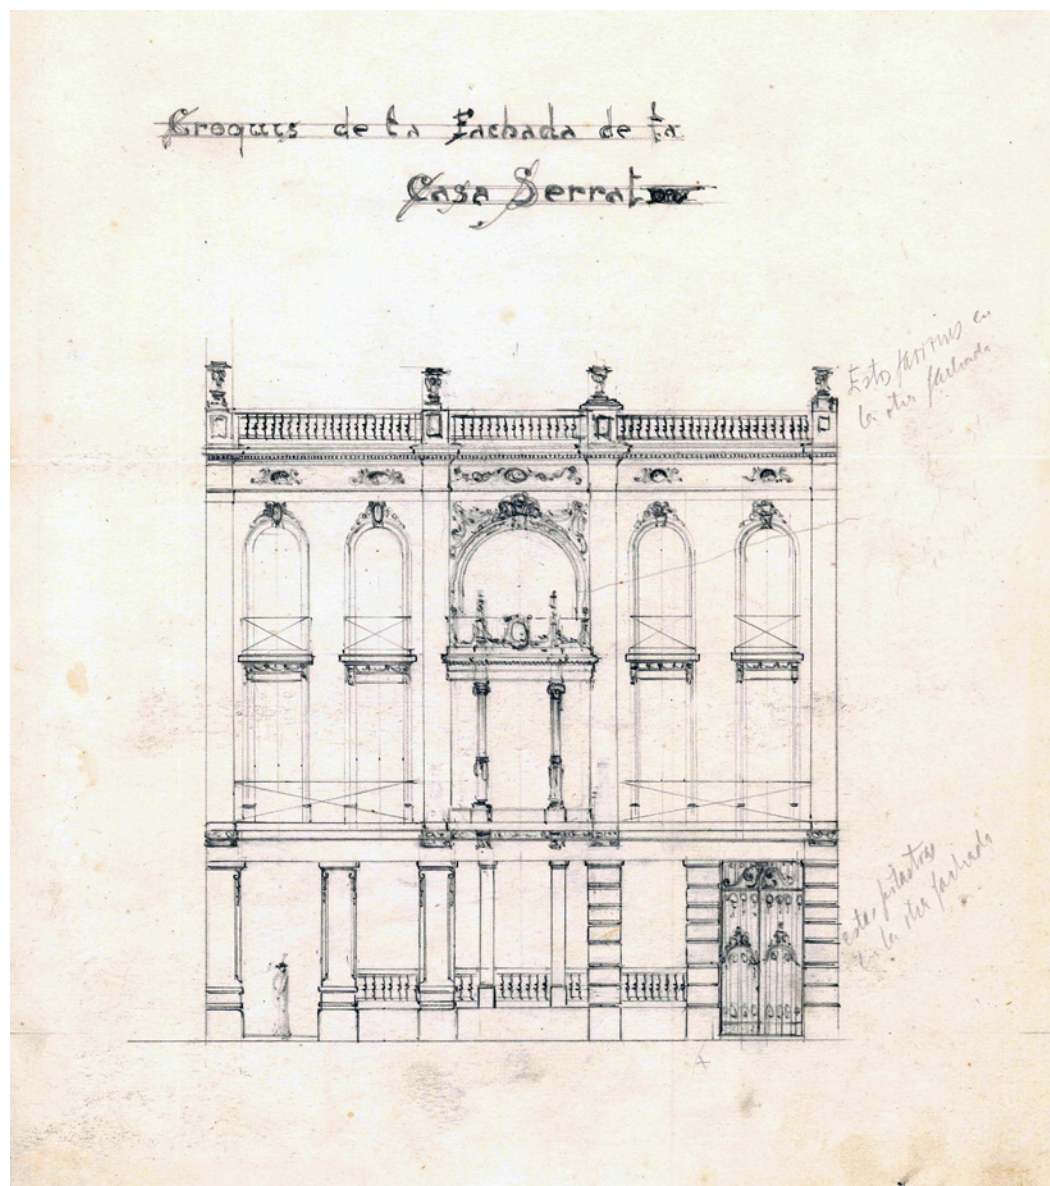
Croquis primero de la fachada de la Casa Serrat. Archivo Lorenzo Ros.
